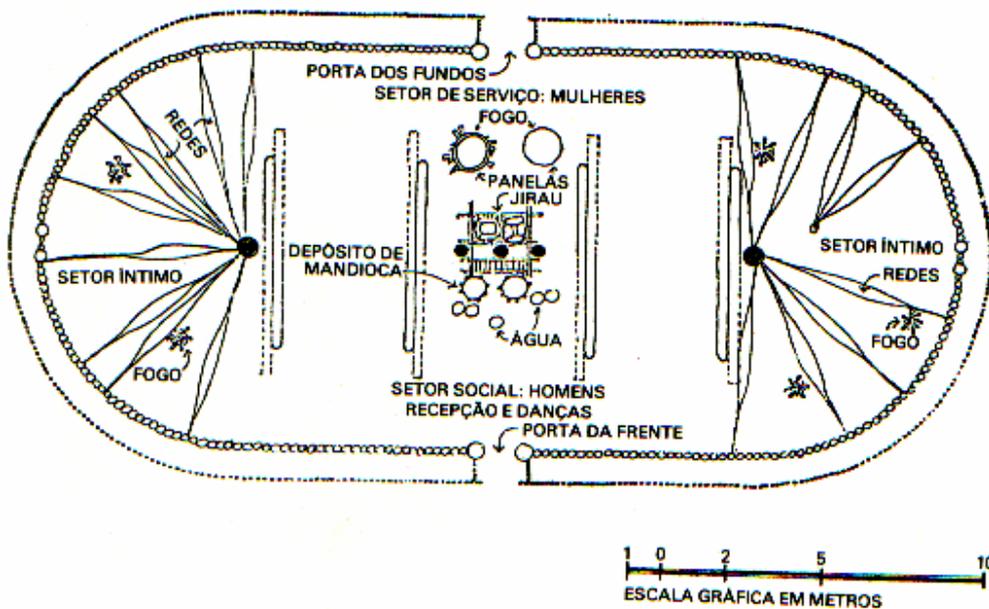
CASA YAWALAPITI – PLANTA BAIXA
